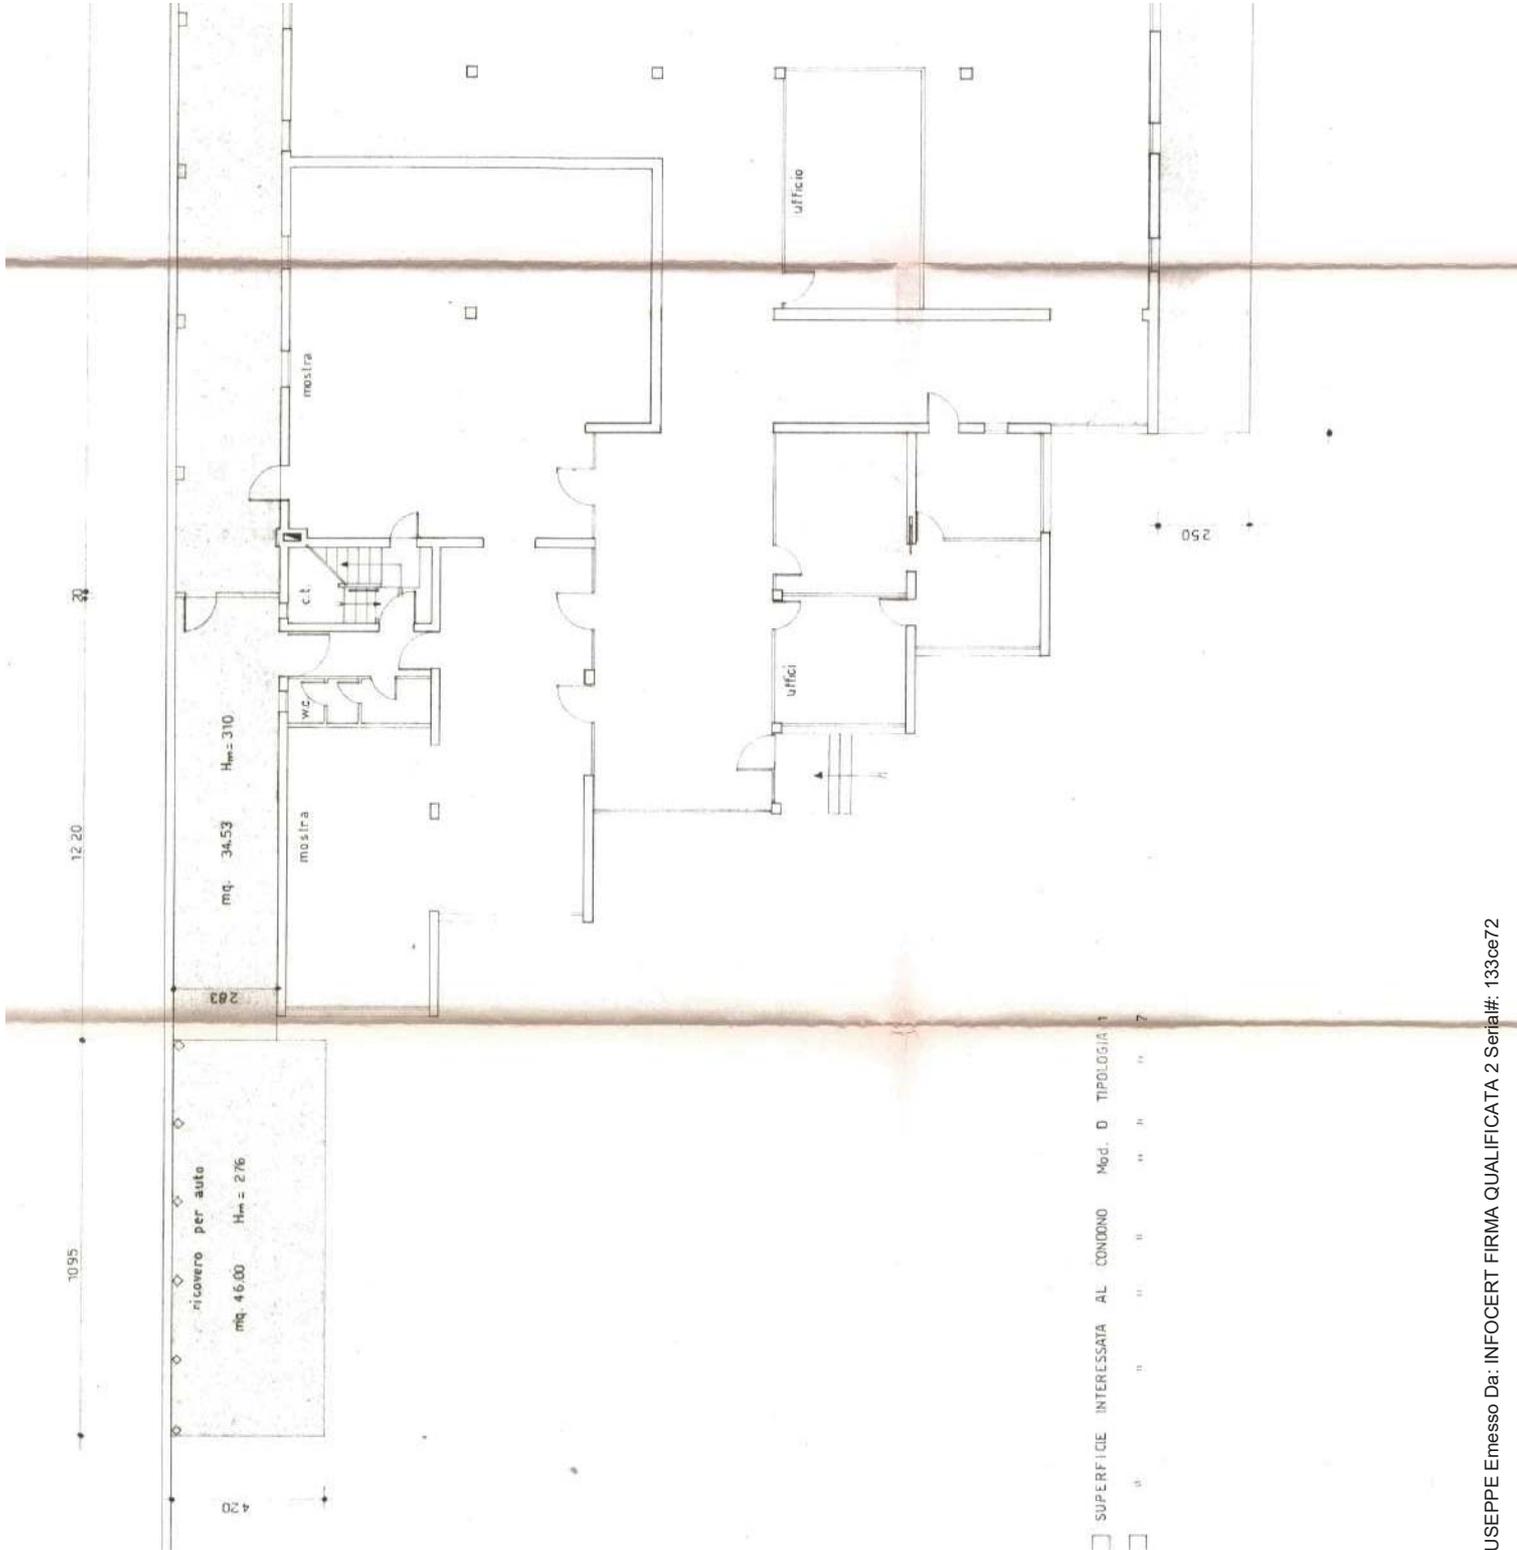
estratto (*fuori scala*) pianta piano terra C.E. in sanatoria Prot. gen. n. 20880 bis-86 N.
